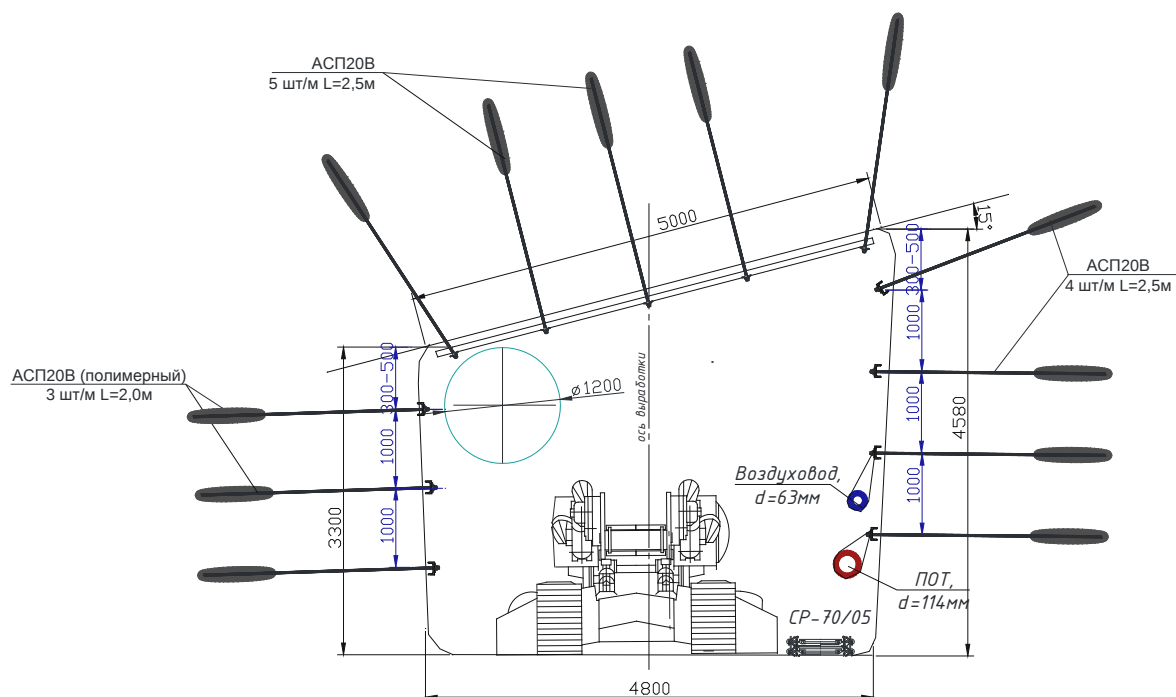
Поперечное сечение вентиляционного штрека (существующий вариант)
